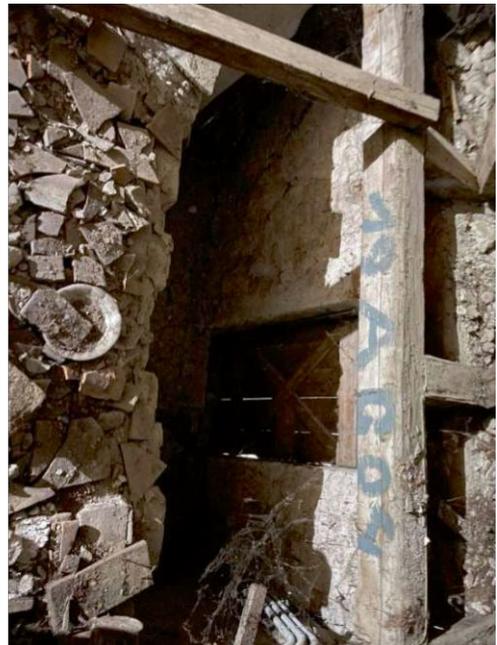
Zugang zu dem Dachboden des Turmes- DB.03, 2024
